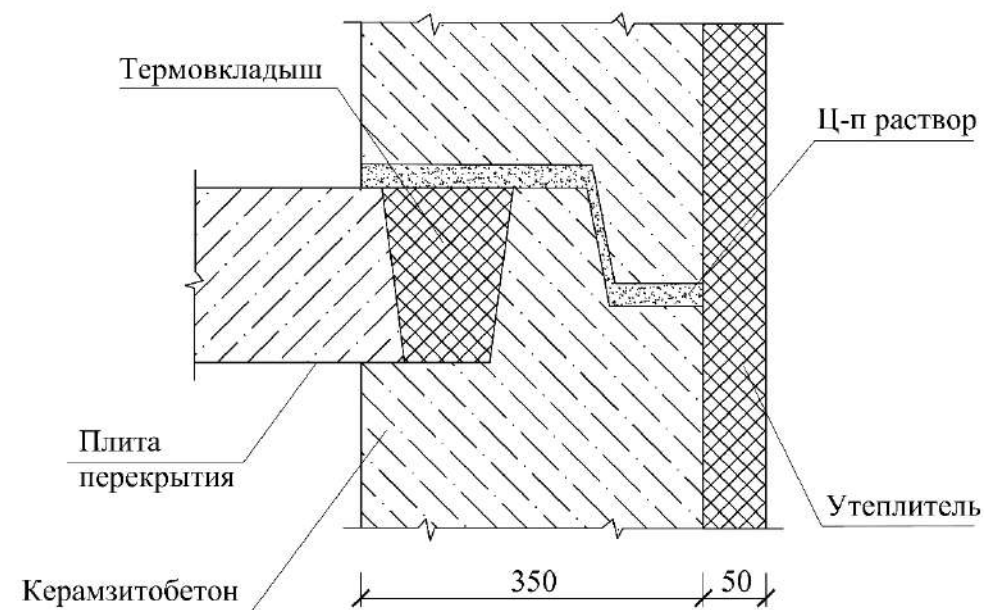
Конструктивный состав опирания плиты перекрытия на наружную стеновую панель
